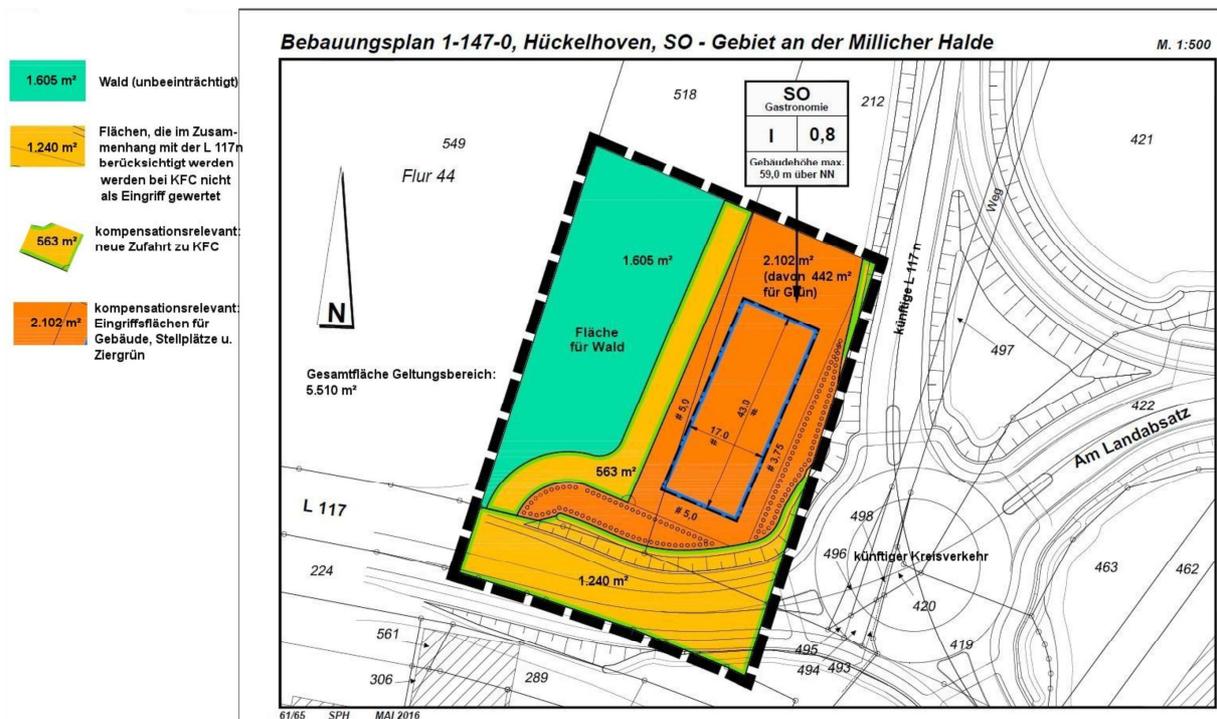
Geplante Situation mit Flächenübersicht und Benennung der kompensationsrelevanten Flächen
